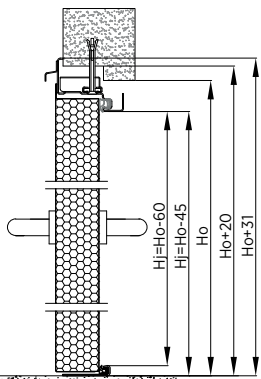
Pose au mur - bloc-porte à deux vantaux - bâti angulaire à rupture de pont thermique - coupe verticale
